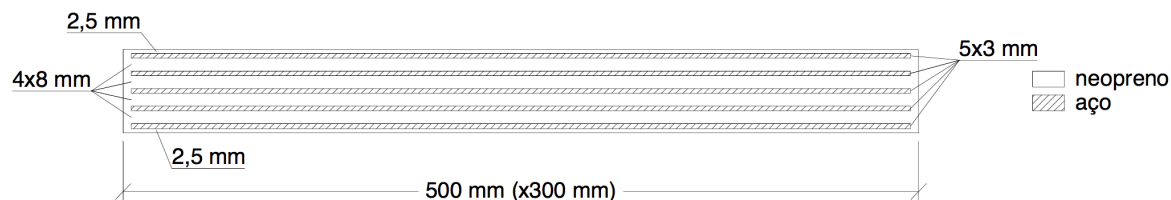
Secção transversal do apoio (Fernandes, 2010)
